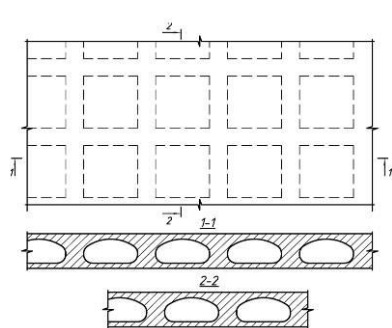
Конструкція перекриття з окремими квадратними в плані вставками
